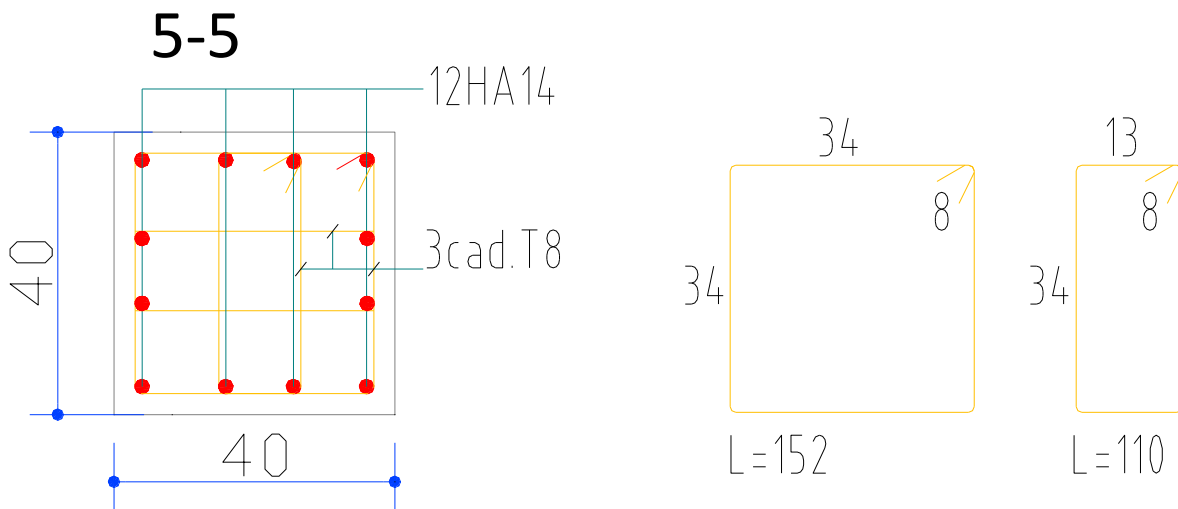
Coupe de ferrailage des poteaux $40 \times 40 \text{ cm}^2$.
